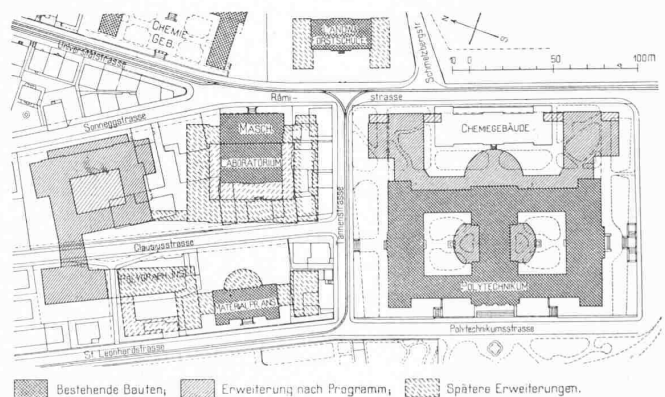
Erweiterungsbauten der E. T. H. laut Entwurf 1909. — Lageplan 1 : 4000.
